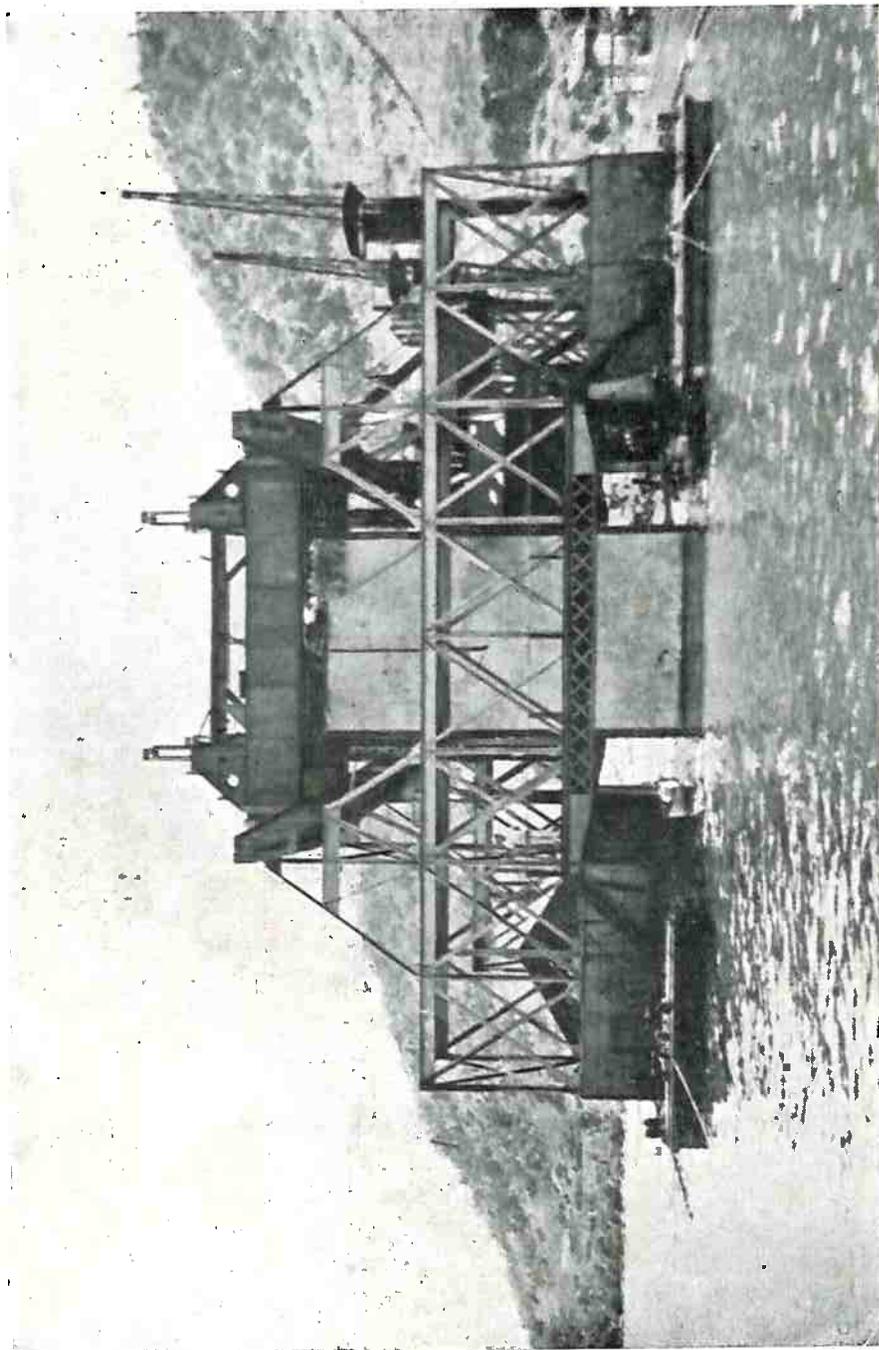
b — Suspensão e locação do caixão pilar da ponte de Laranjeiras.
